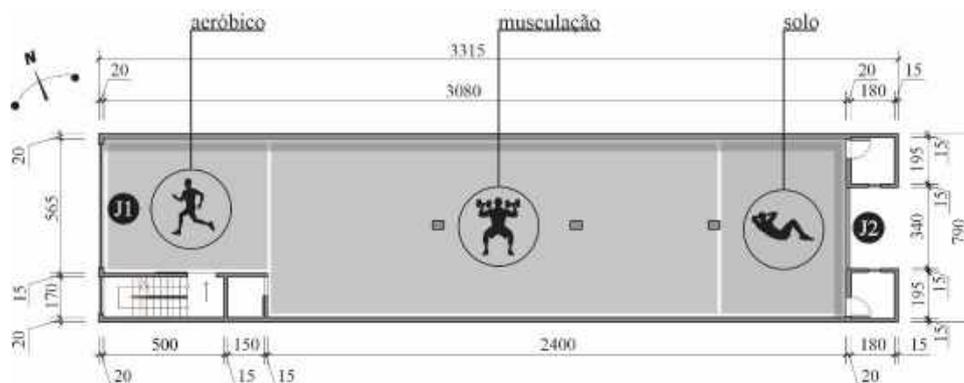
Planta e disposição do espaço interno da academia estudo de caso
